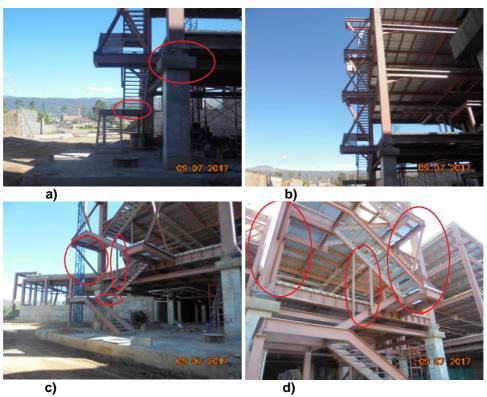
Construcción de una grada de emergencia; a) Discontinuidad de la grada y aislador sísmico; b) Diagonales unidas a los nudos y vigas para soportar la grada; c) Diagonal, separación de la grada y elemento vertical que sostiene la grada; d) Diagonales y elementos verticales.
